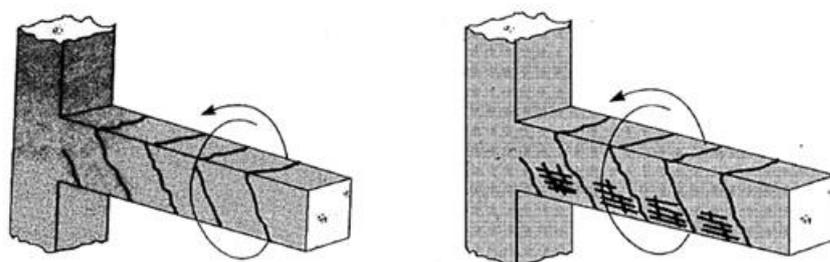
OTRO TIPO DE FISURACIÓN POR TORSIÓN
